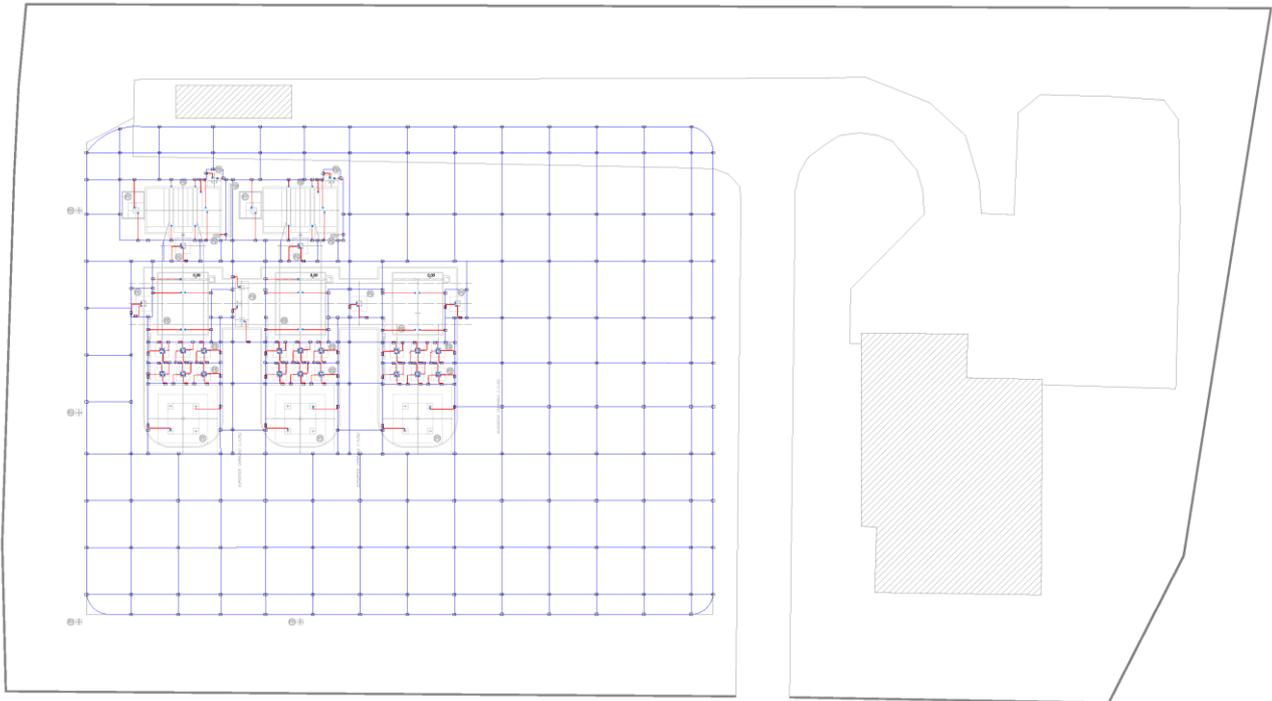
Stralcio planimetrico rete di terra cabina primaria Melfi
